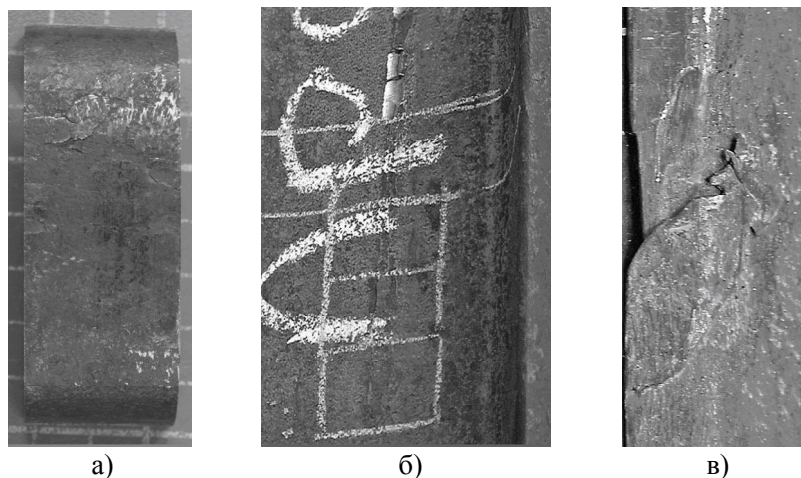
Внешний вид дефектов: а) головка; б) шейка; в) подошва
